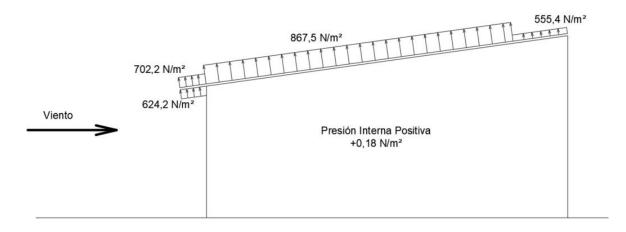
Presiones de diseño para el SPRFV, viento paralelo a la pendiente de cubierta
